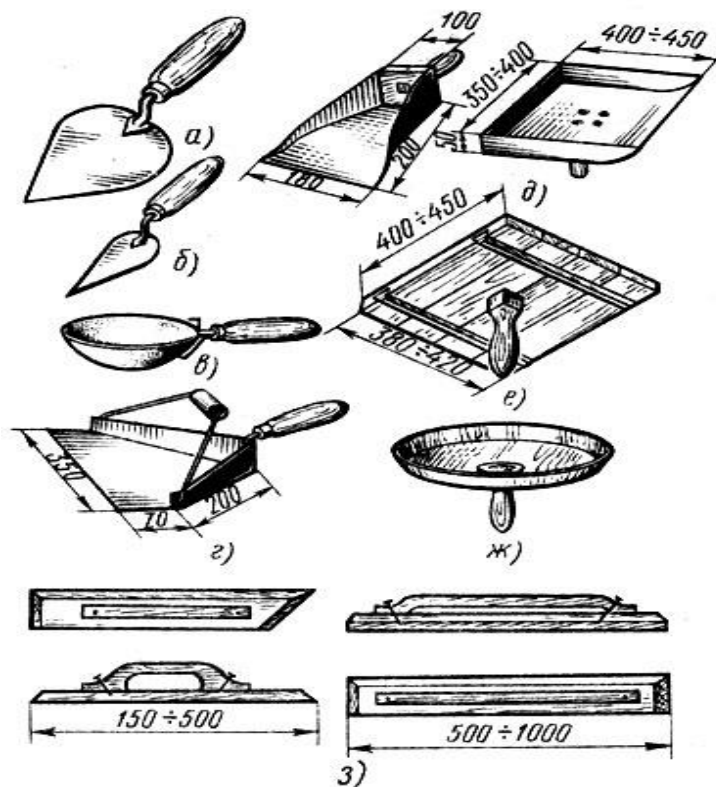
Инструменты для нанесения и разравнивания раствора: а - штукатурная лопатка, б - отрезовка, в - ковш, г - совок с качающейся ручкой, д - совок-лопатка и сокол-ковш, е - прямоугольный сокол, ж - тарельчатый сокол, з - полутерки
